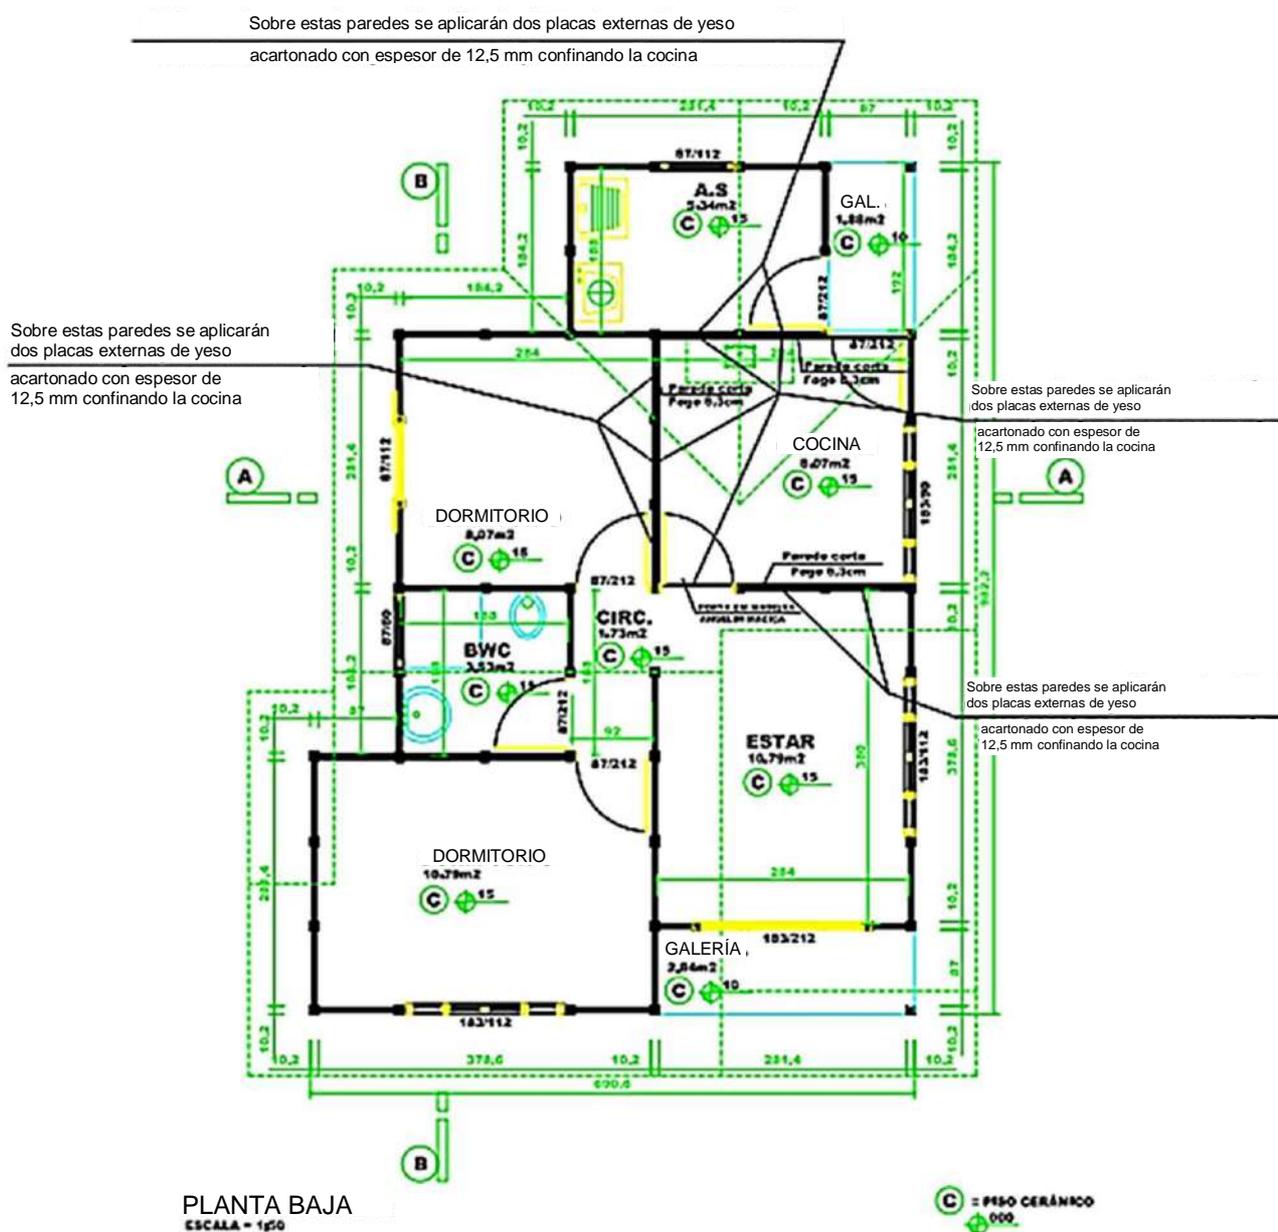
Planta baja de la unidad habitacional unifamiliar terrestre aislada.
